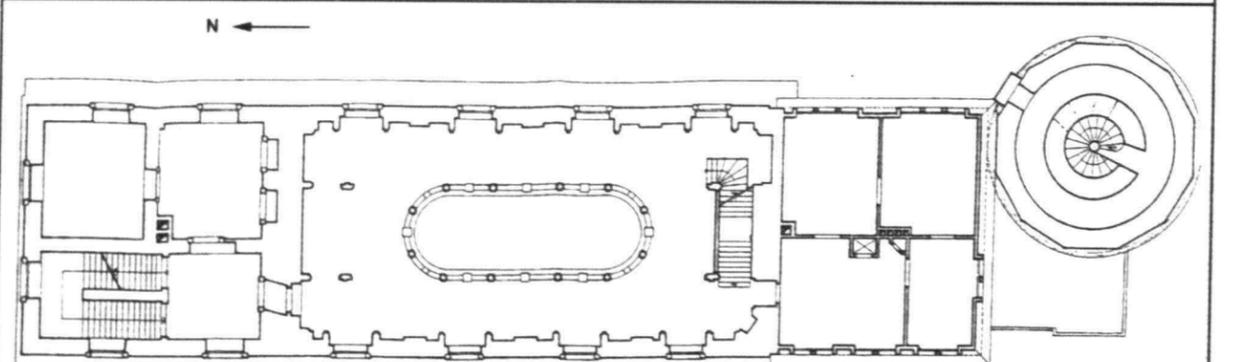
Grundriss des dritten Obergeschosses
